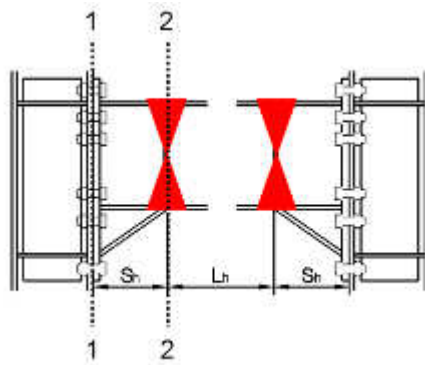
Position des rotules plastiques dans les poutres avec jarrets
